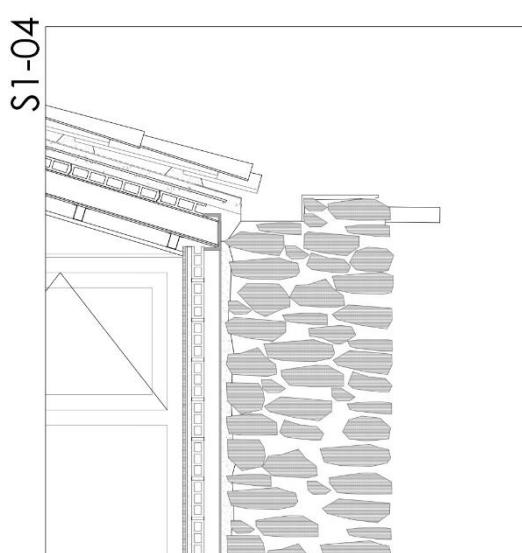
Detalle constructivo (solución proyecto básico) [DMP Arquitectural]
